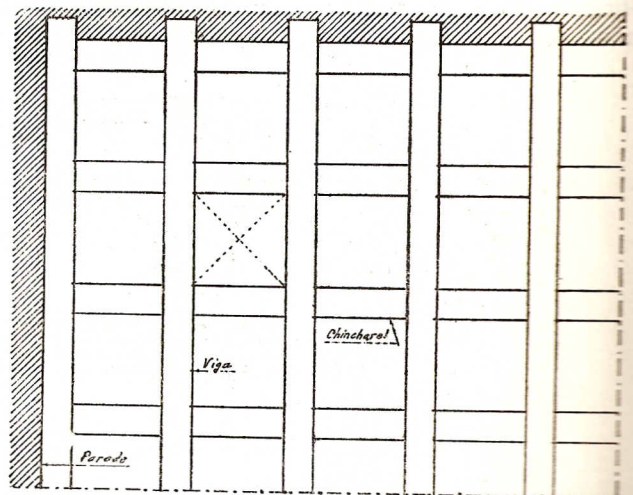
PLANTA DA ESTEIRA DE TECTO ARTEZOADO
